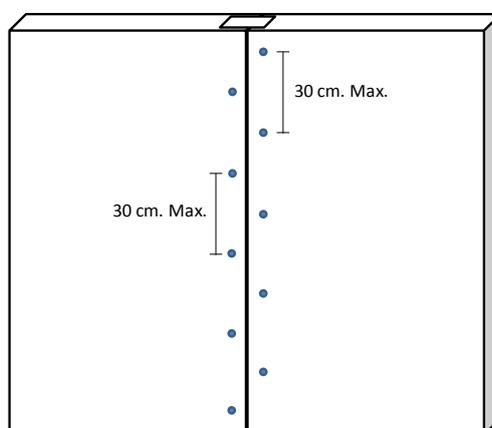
Conexión entre paneles de pared con Lengüetas
